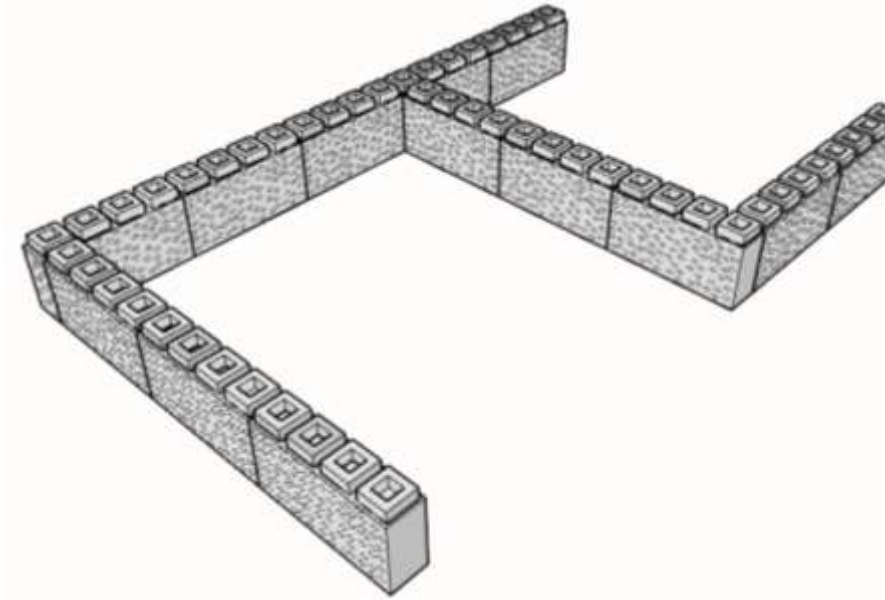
Colocación de Mampostería Bloques de Reciclado
